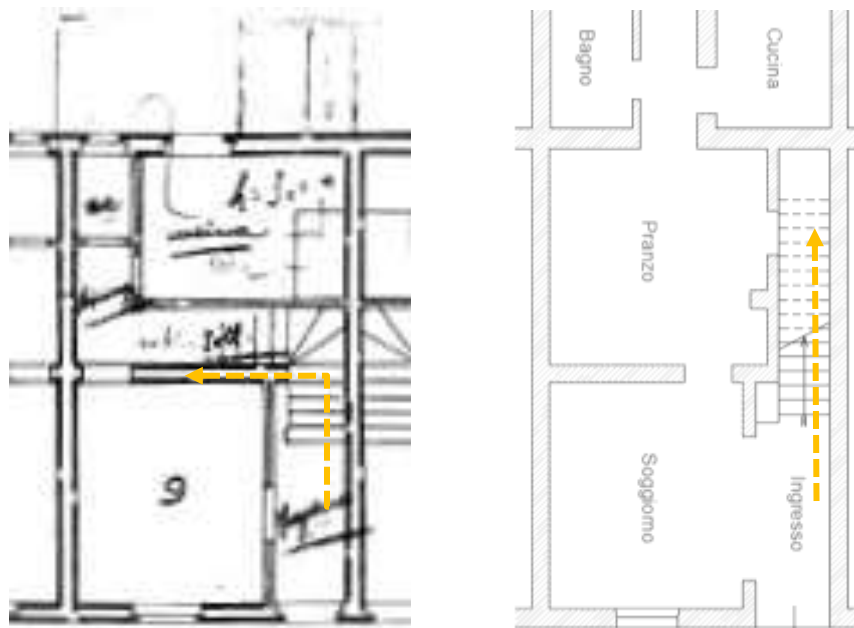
Confronto tra la planimetria con schizzo redatto dall'Ute nel 1947, ed il rilievo eseguito durante il sopralluogo
